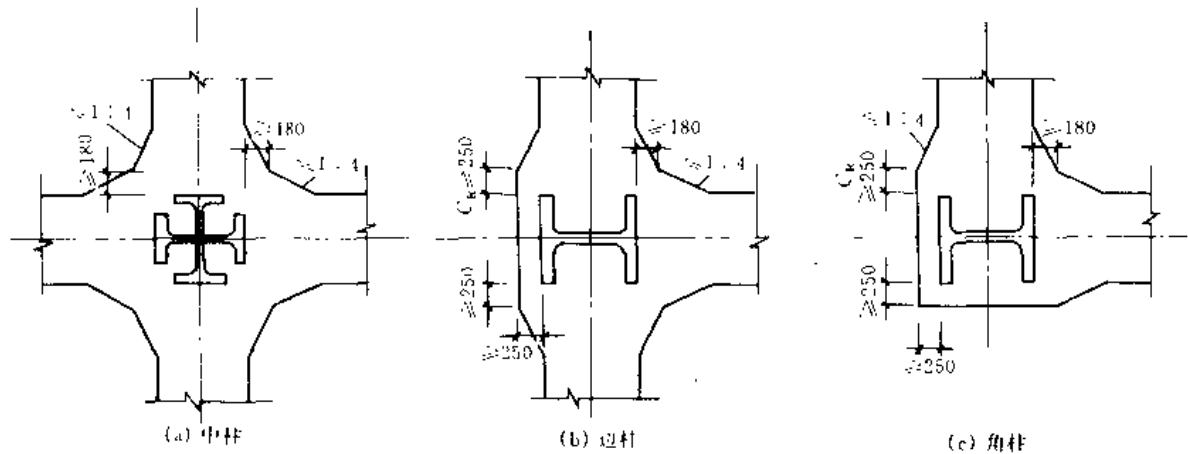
埋入式柱脚的混凝土保护层厚度
